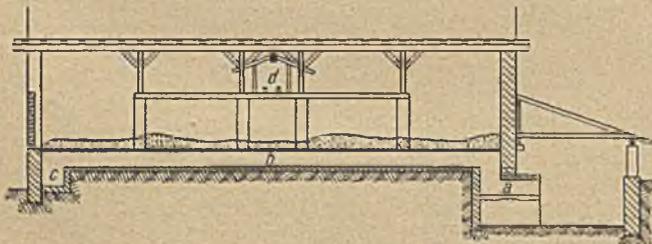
Längsschnitt durch die heizbare Plandarre.
